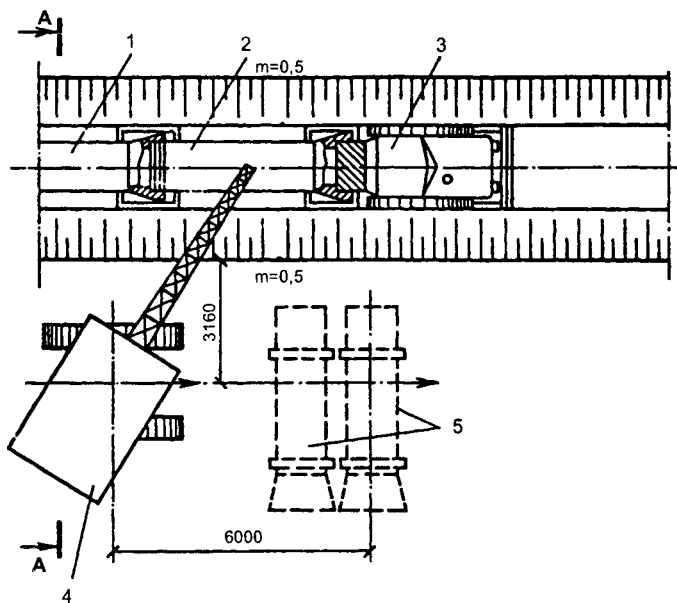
Монтаж железобетонных труб диаметром 1000–1200 мм с помощью бульдозера:
